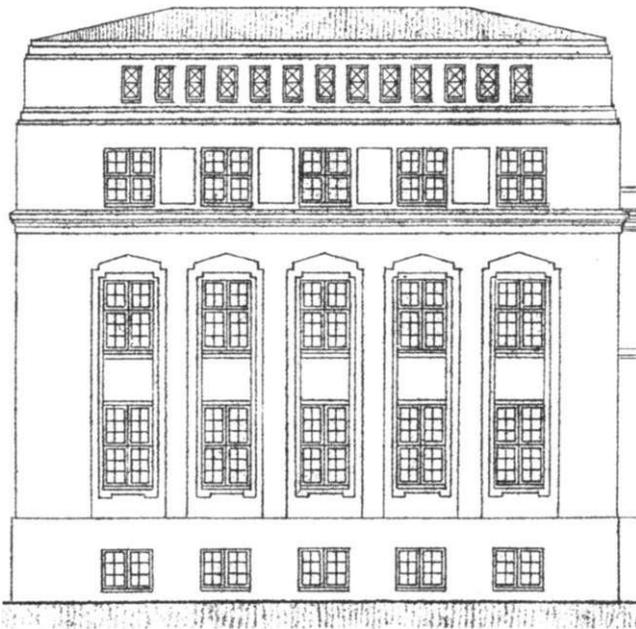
Verwaltungsbau Schönebecker Straße 66,
